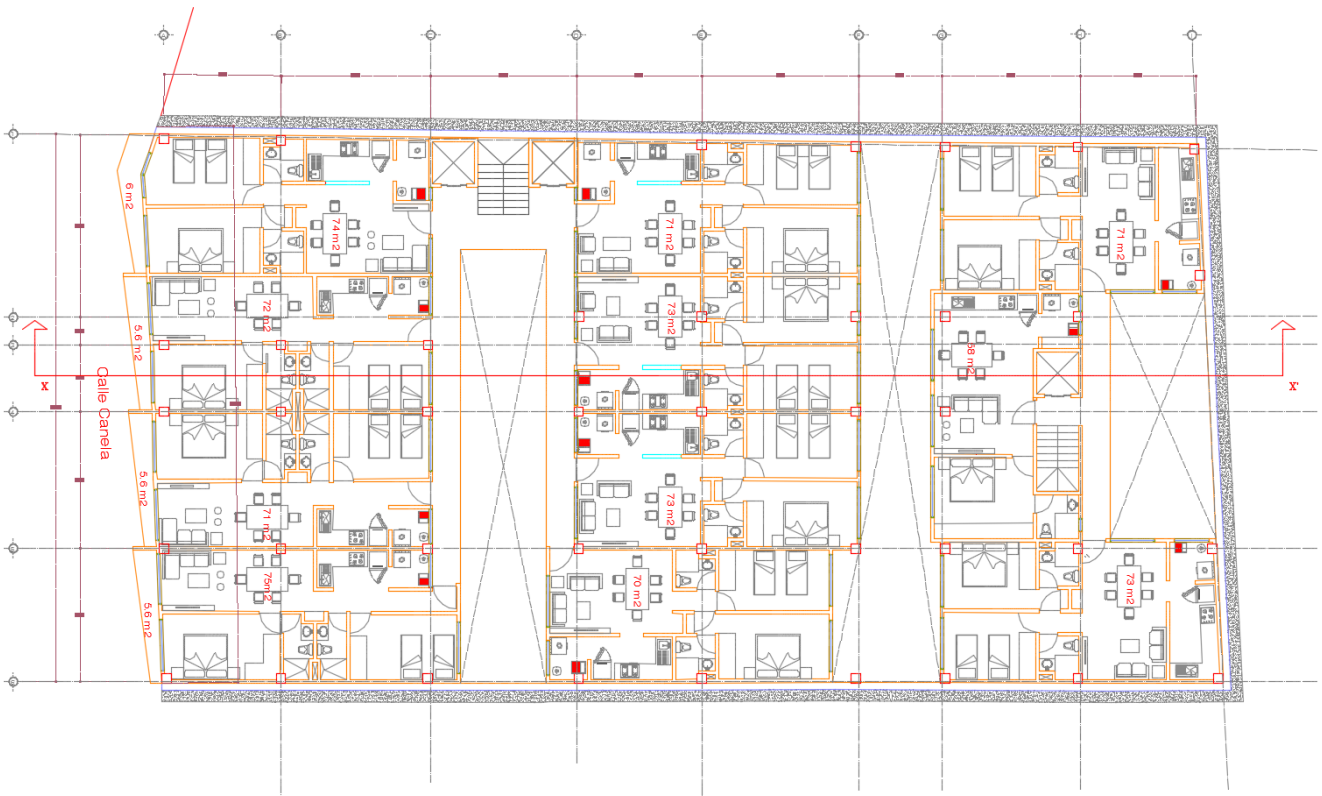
PLANTA ARQUITECTÓNICA PLANTA TIPO 2, 4, 6 y 8
